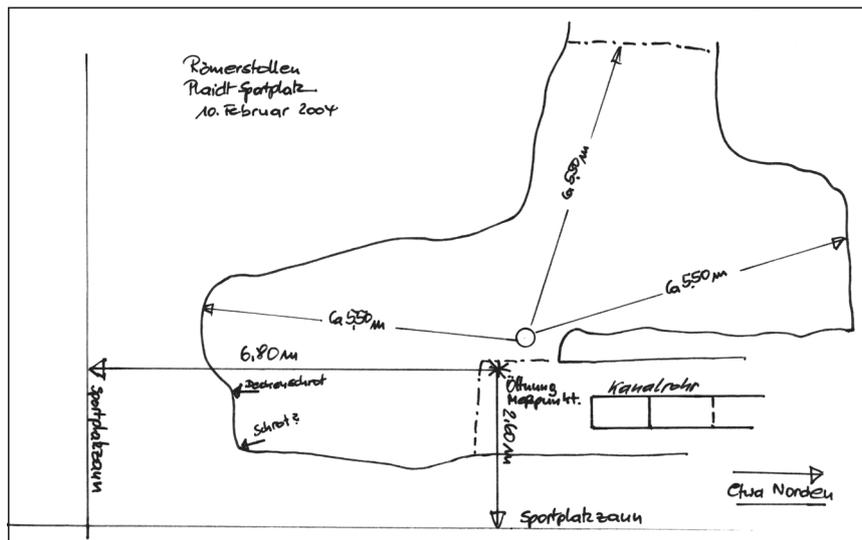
FS 47, Am Sportplatz. Grundrisssskizze. – (Skizze W. Horch).
